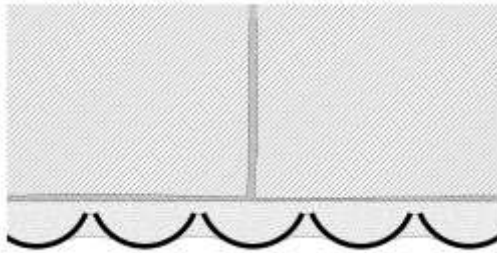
| Detalhamento construtivo de empena revestida em telha cerâmica capa-canal, com a parte convexa da telha orientada para o exterior e as juntas entre as telhas preenchidas com argamassa. (desenho do autor)
